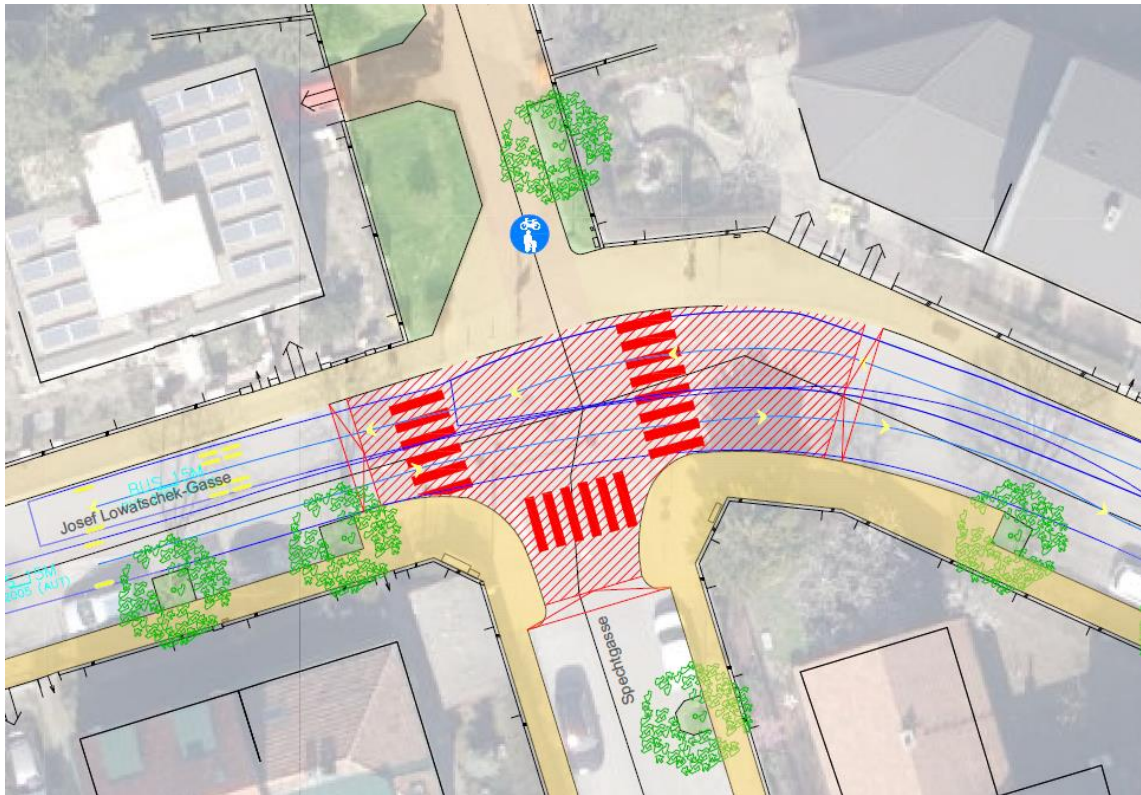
Ausschnitt Planungsvariante 2 Josef Lowatschek -Gasse # Spechtgasse
